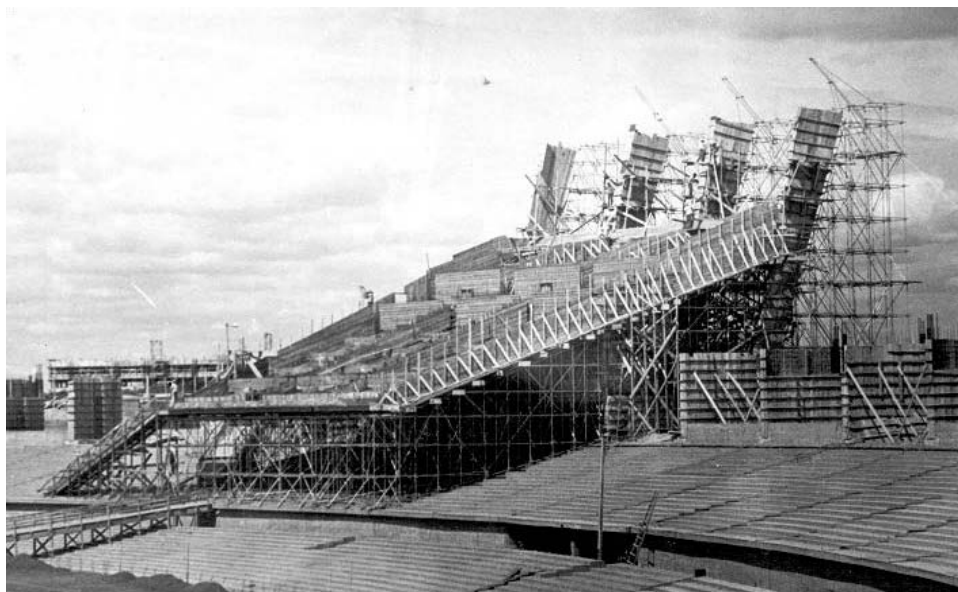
Vista interna da forma e do escoramento das lajes e vigas da arquibancada do setor 15, que serviu como setor piloto para possíveis adequações executivas
